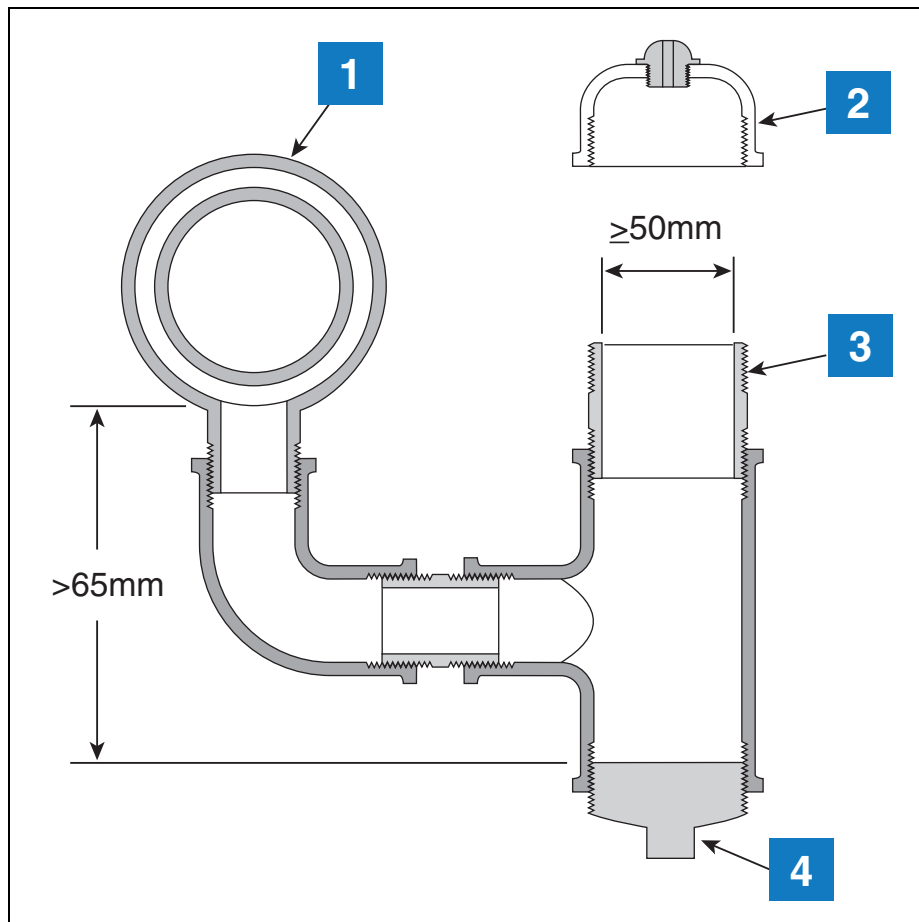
Пример установки сборника трубопровода с двойной обшивкой
